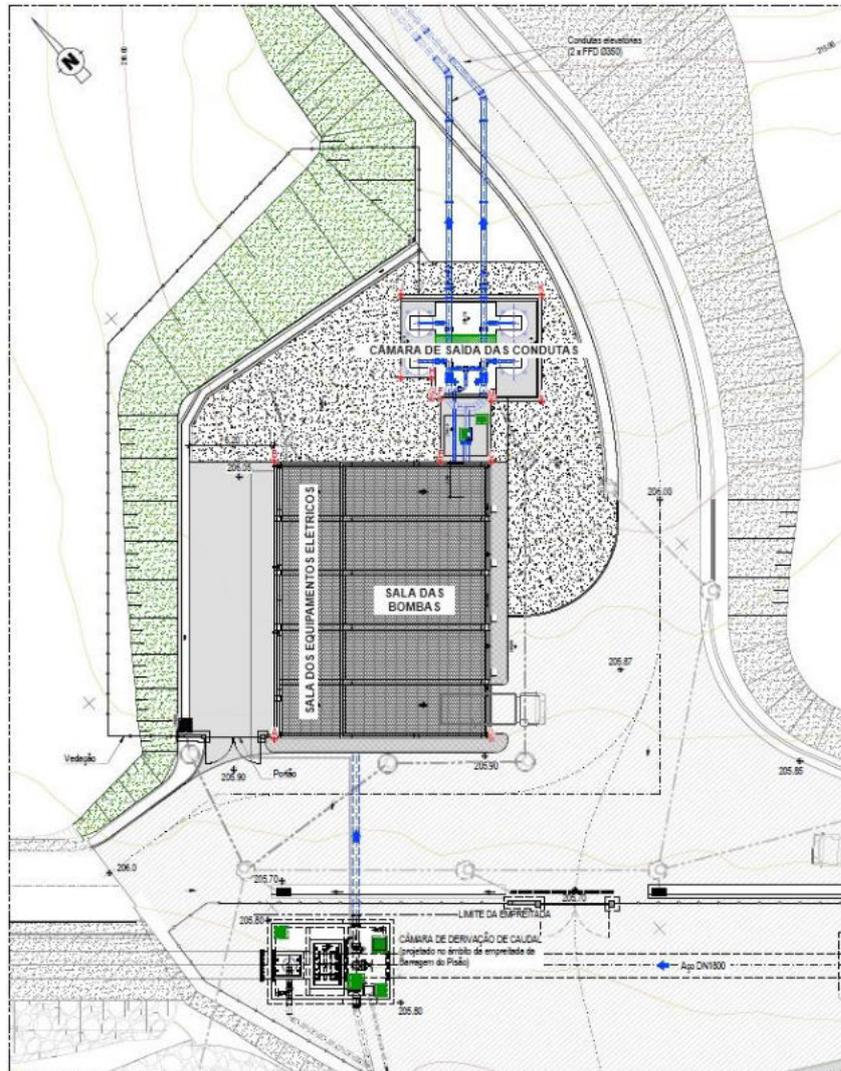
Planta de Implantação da Estação Elevatória de reforço de abastecimento de água à ETA da Póvoa.
